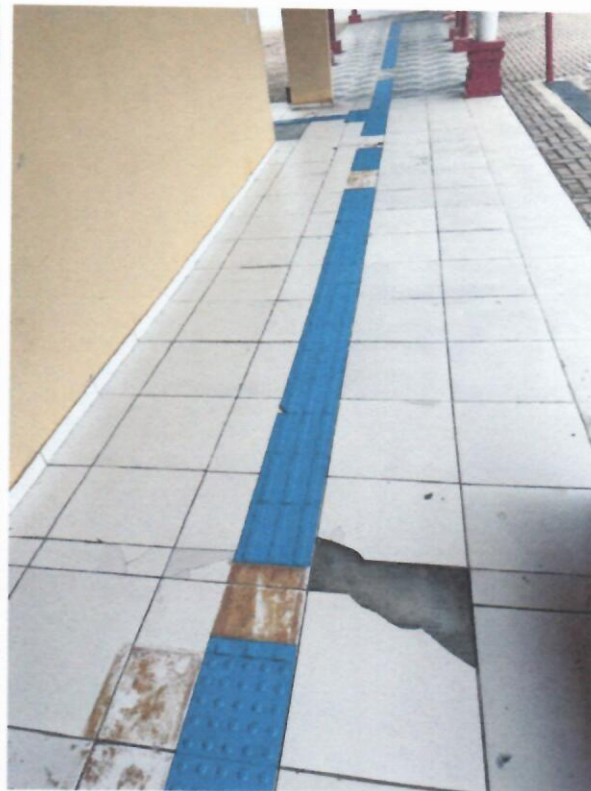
e 2 – Piso manchado; cerâmica trincada; piso tátil descolado.
